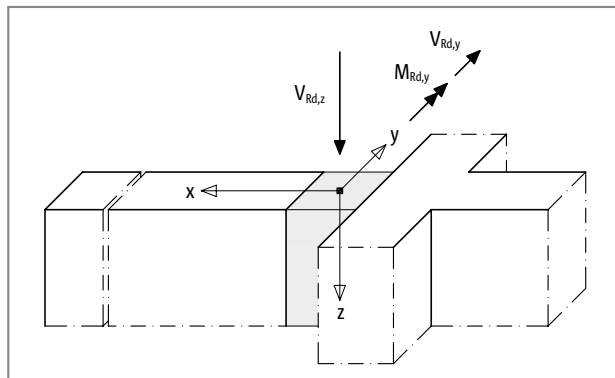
Schöck Isokorb® XT Typ W: Vorzeichenregel für die Bemessung
